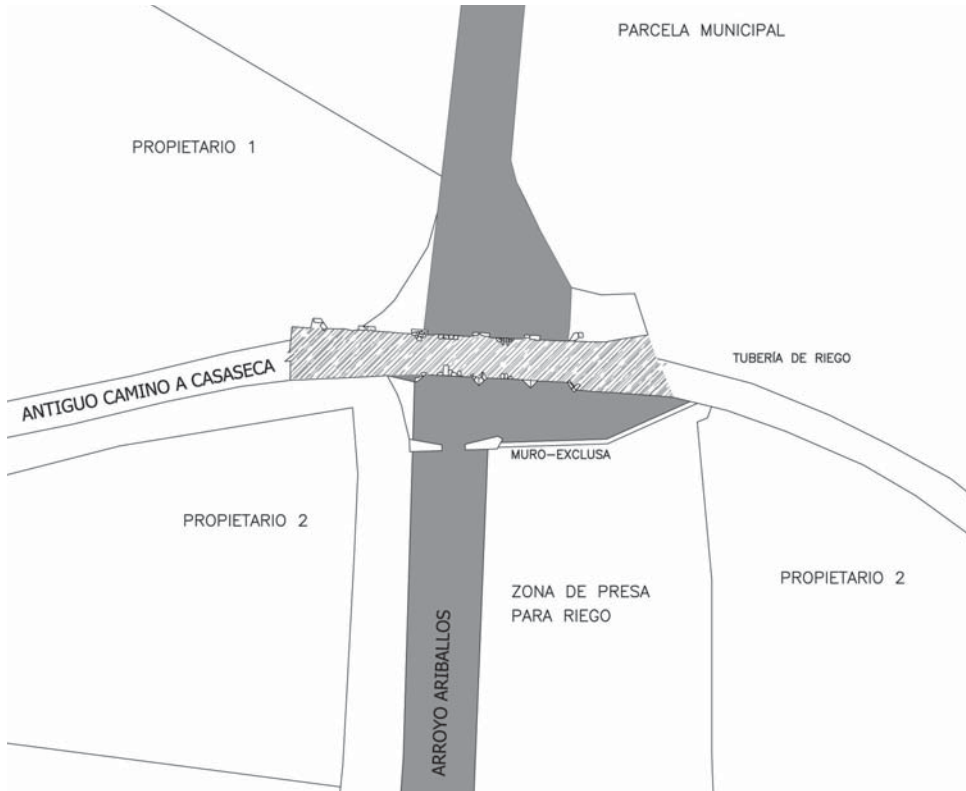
Plano de situación. Proyecto de limpieza. (L.P.).
